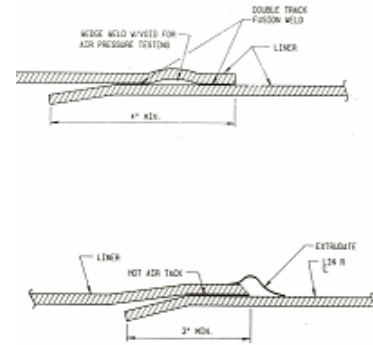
Uniones a) solape con canal de prueba, b) soldadura con aporte por extrusión
